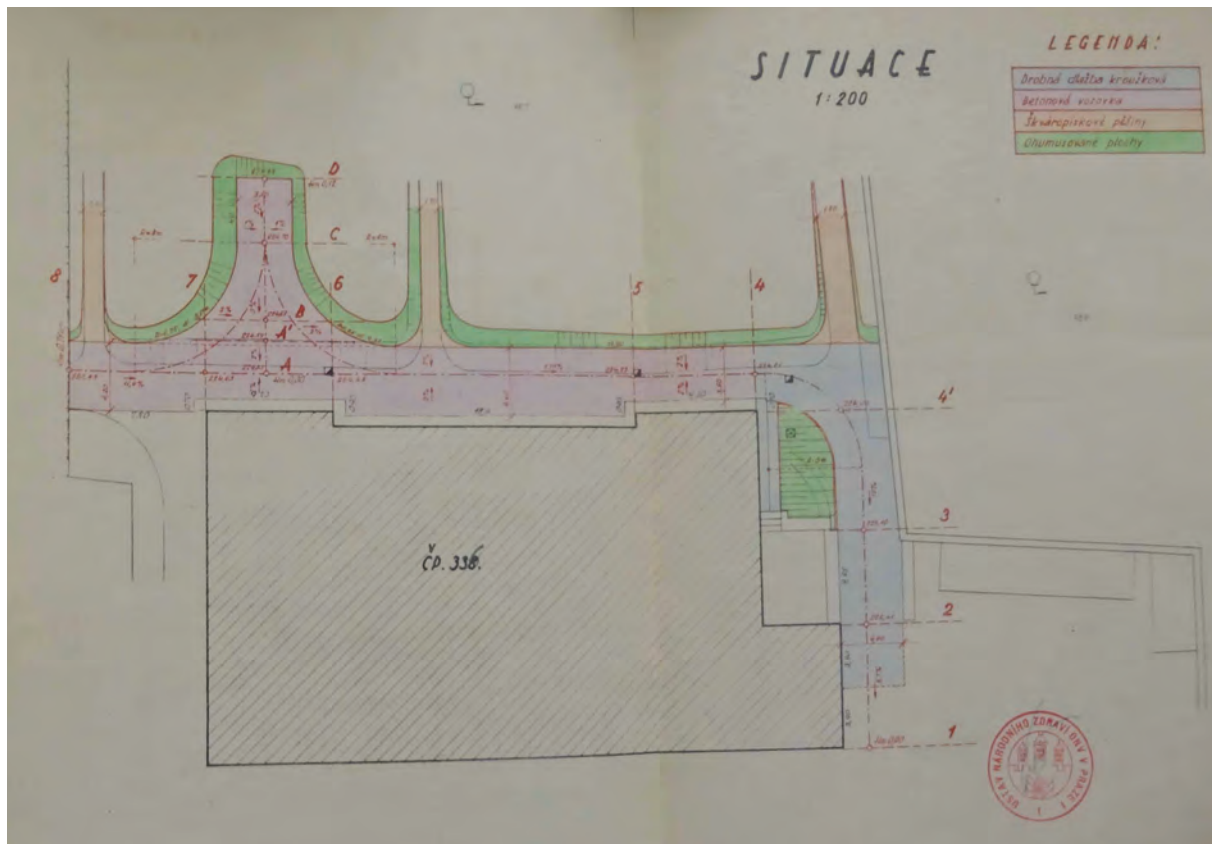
Grundriss, technischer Plan für den Bau einer Zufahrtsstraße nördlich des St. Josefsflügels, Ing. Josef Kočí, gestempelt und unterschrieben durch das Staatliche Gesundheitsamt (Ústav národního zdraví), Prag I, Originalmaßstab 1:200, 1954
